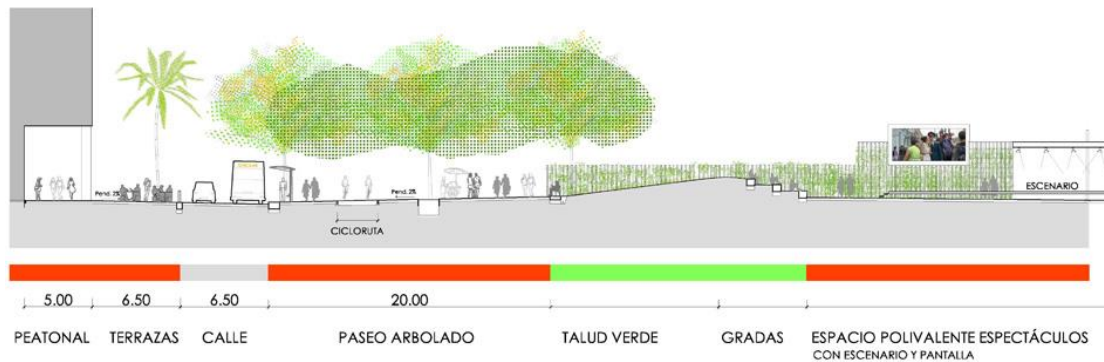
Propuesta Sección Tipo de la Calle Primera (Fuente: Esteyco)
